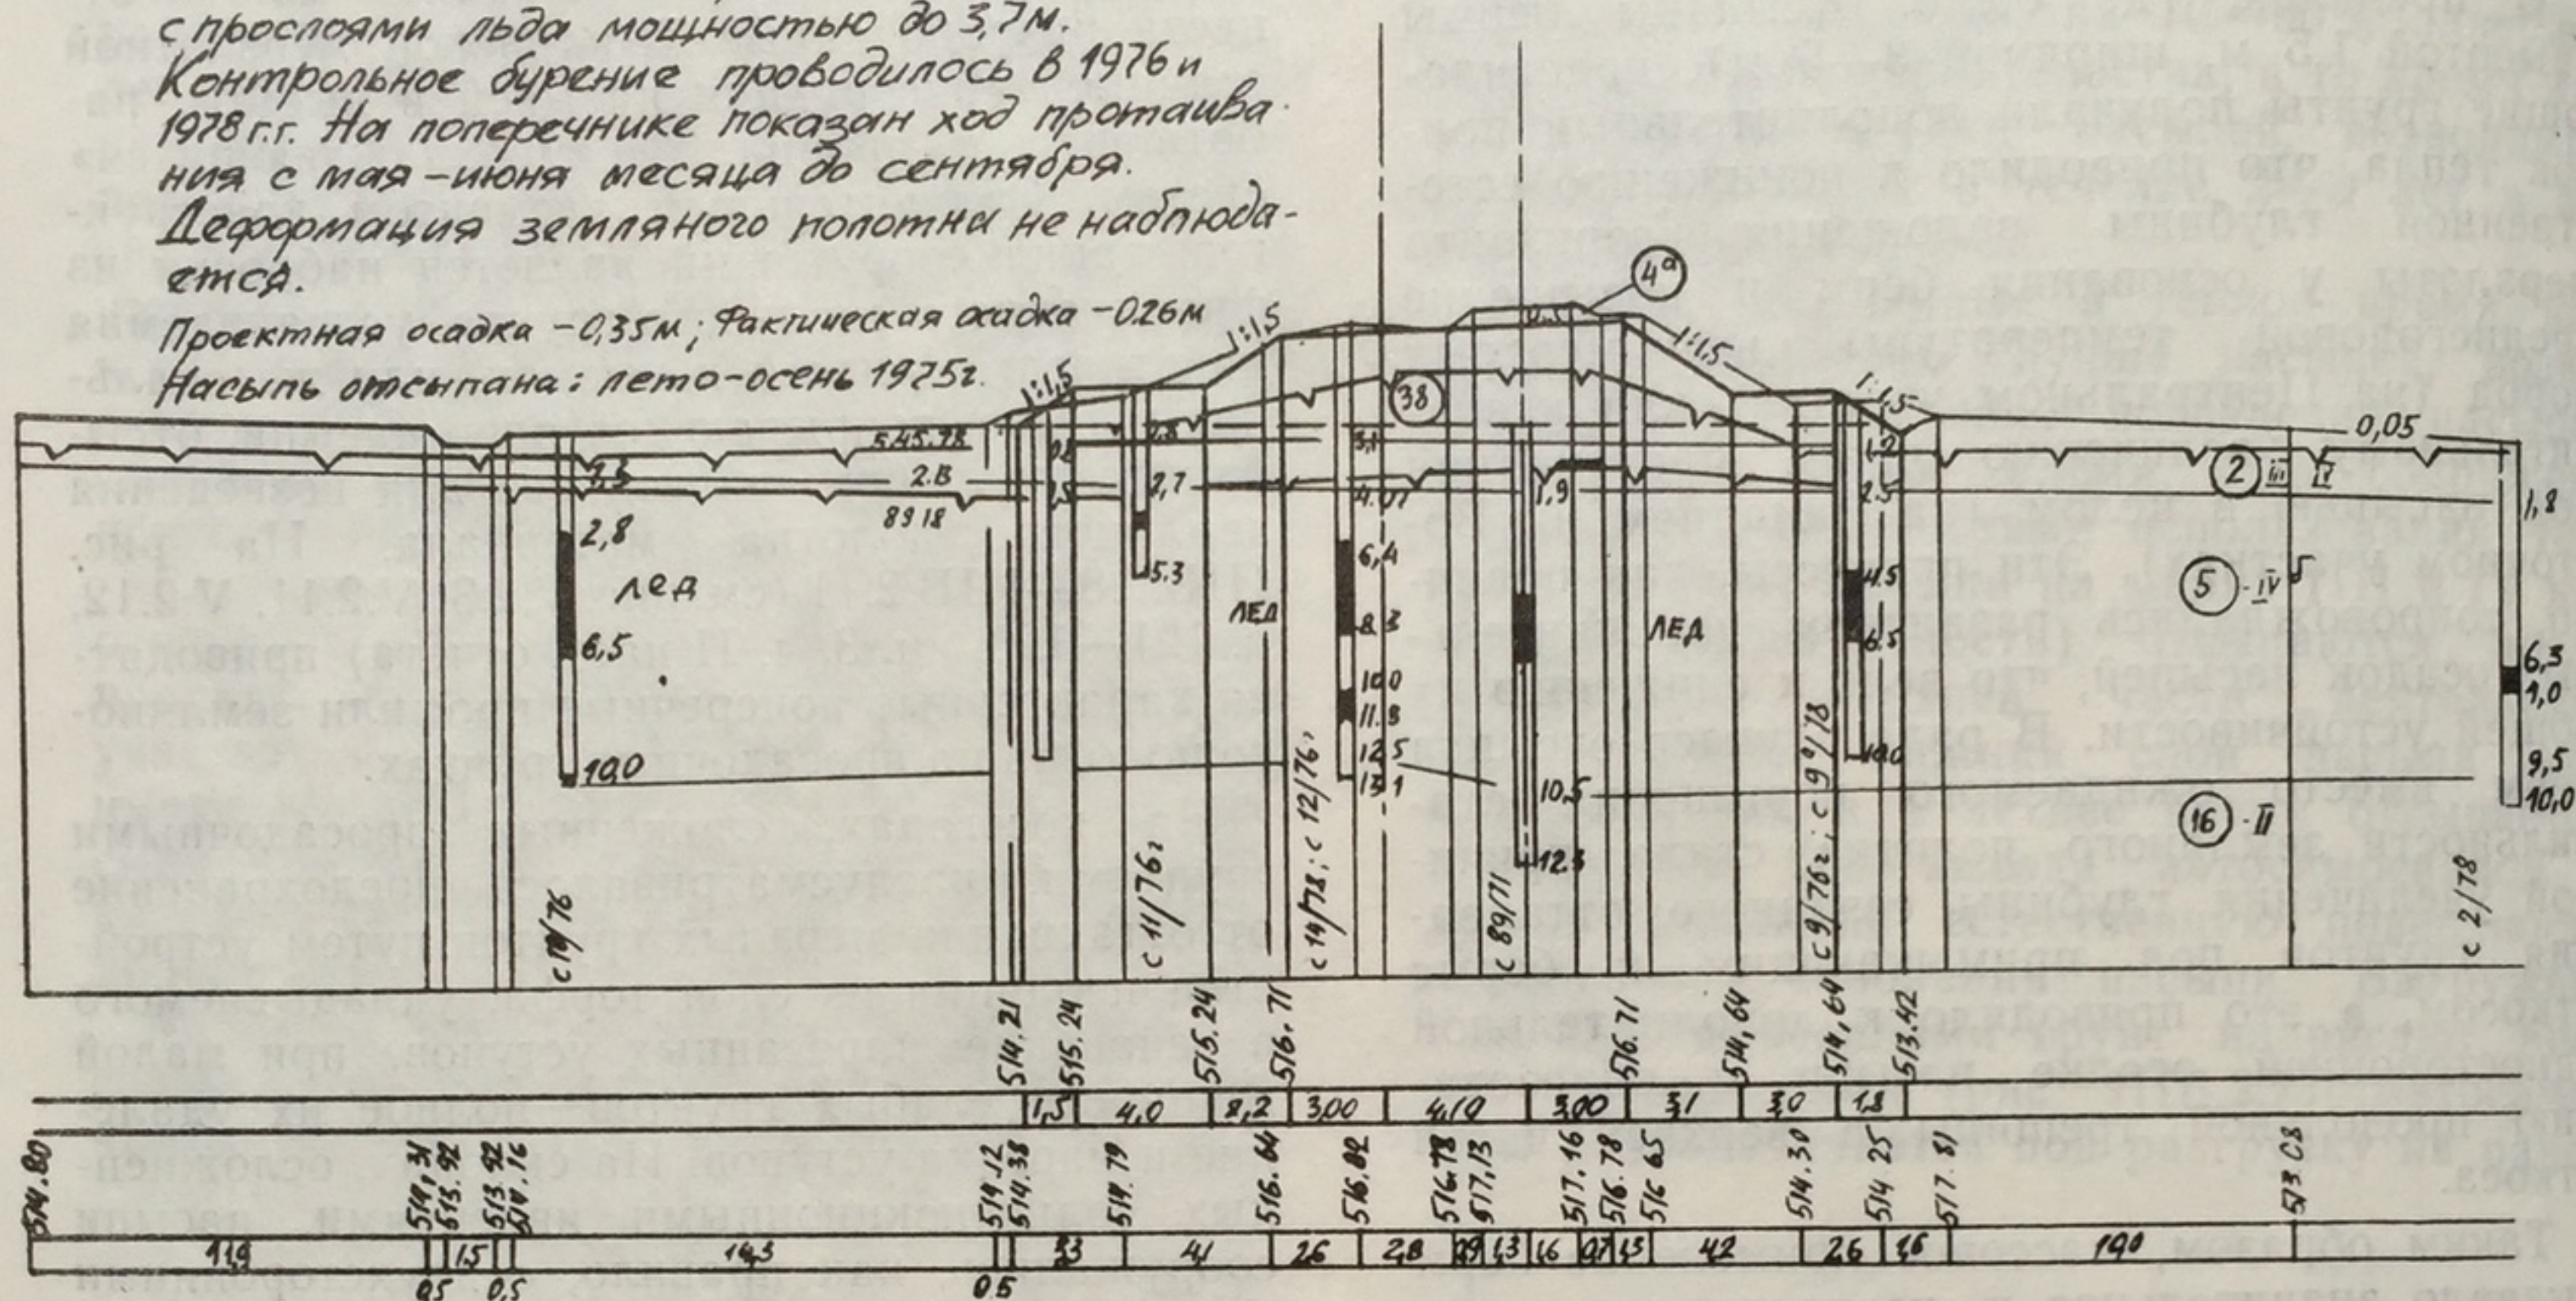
Песчаная насыпь на просадочных грунтах с прослоями льда
